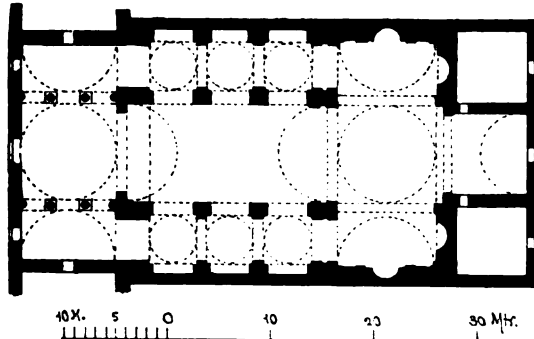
Annunziata zu Arezzo. Grundriss. (Gnauth.)
